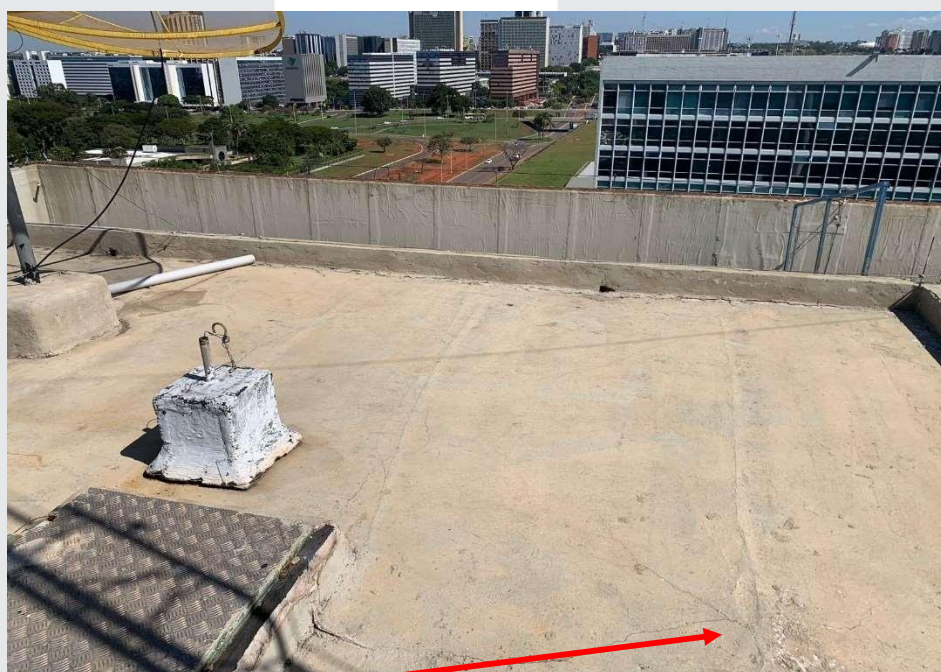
Sistema de impermeabilização em estado avançado de degradação
